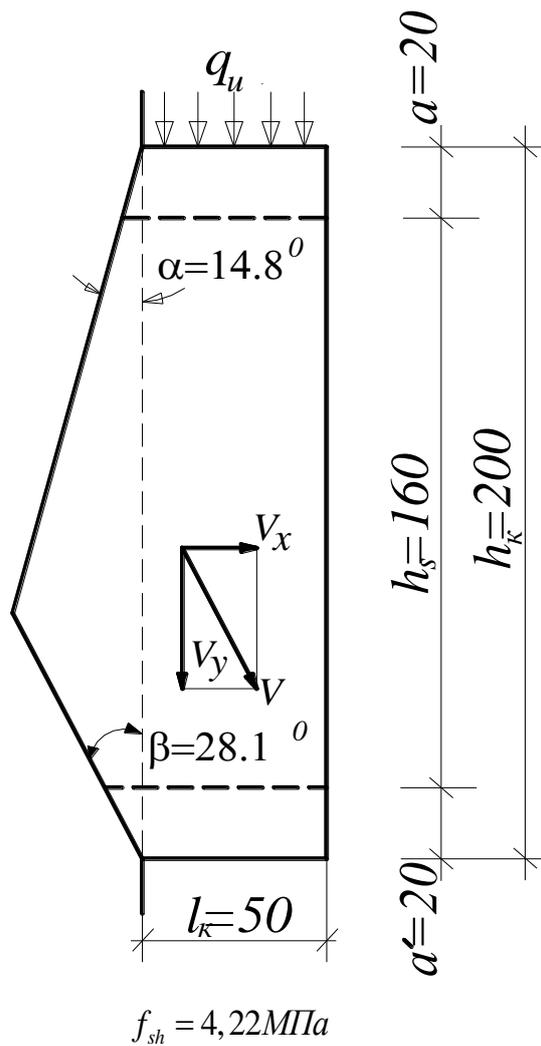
Параметри кінематичної схеми руйнування залізобетонної шпонки із розміщенням арматури у два яруси при врахуванні нагельного ефекту в арматурі обох рівнів
